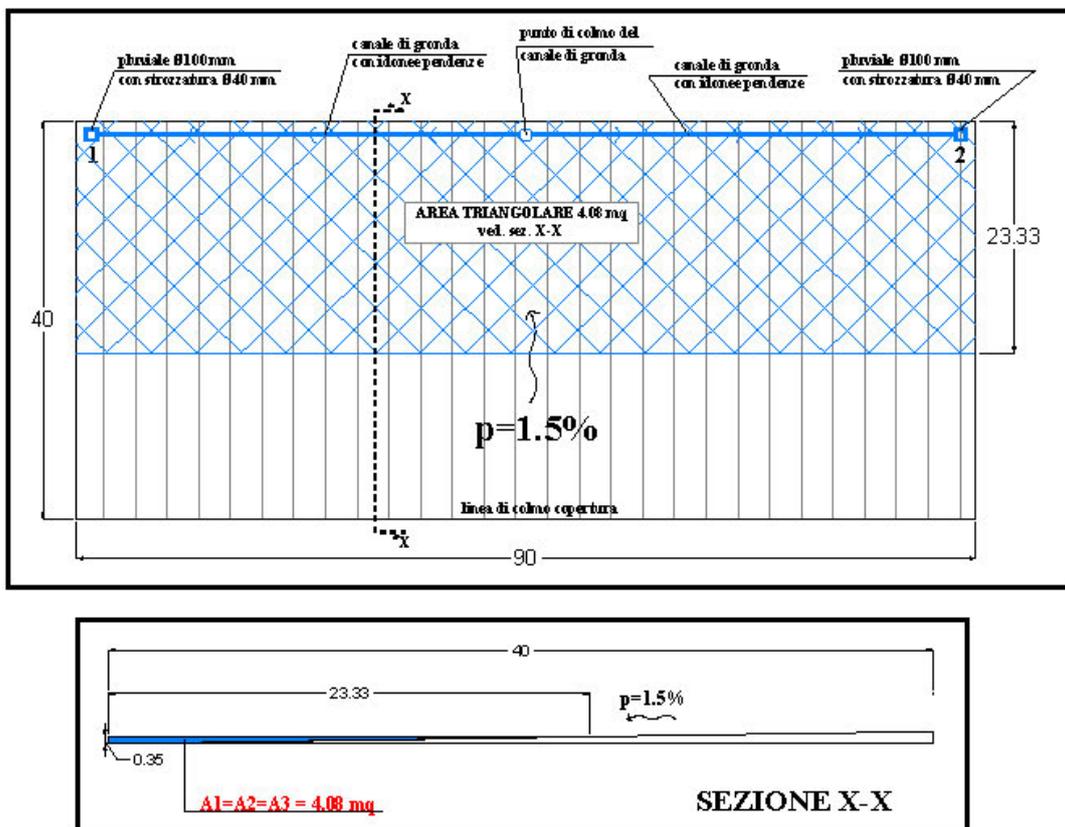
Pianta e sezione trasversale X-X della copertura edifici (celle) n° 1/2/3
